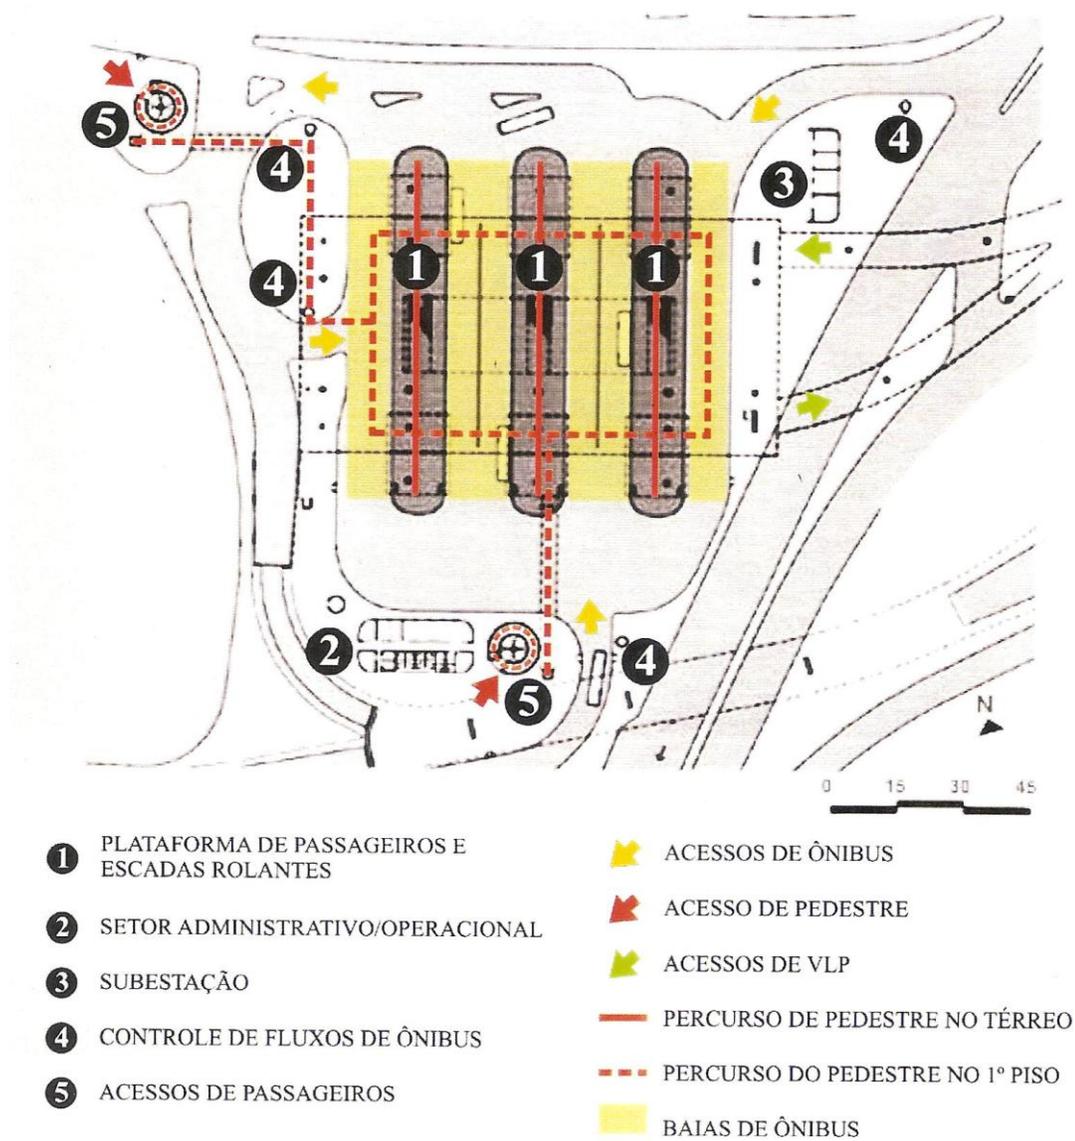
Planta do pavimento térreo do Terminal Sacomã.
